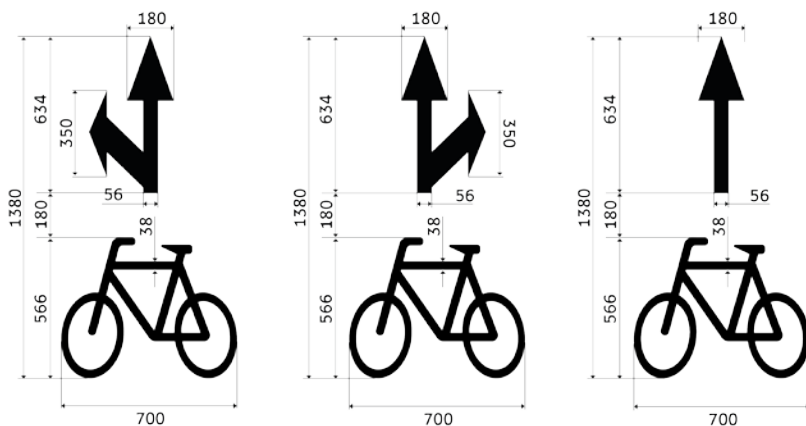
Разметка 1.18.1д и 1.23.2 для обозначения направления движения велосипедистов
